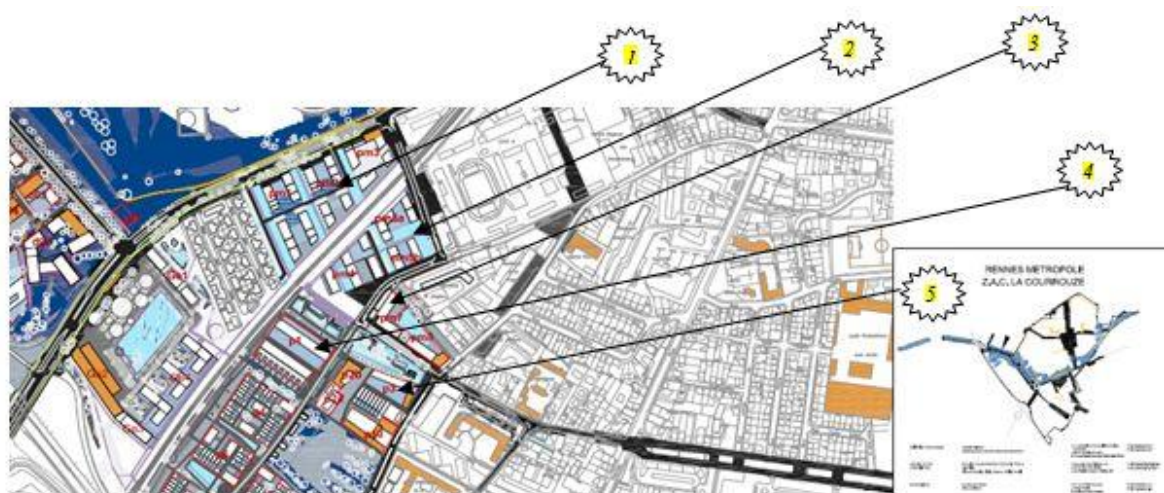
ZAC la Courrouze avril 2017 – Détail des constructions
